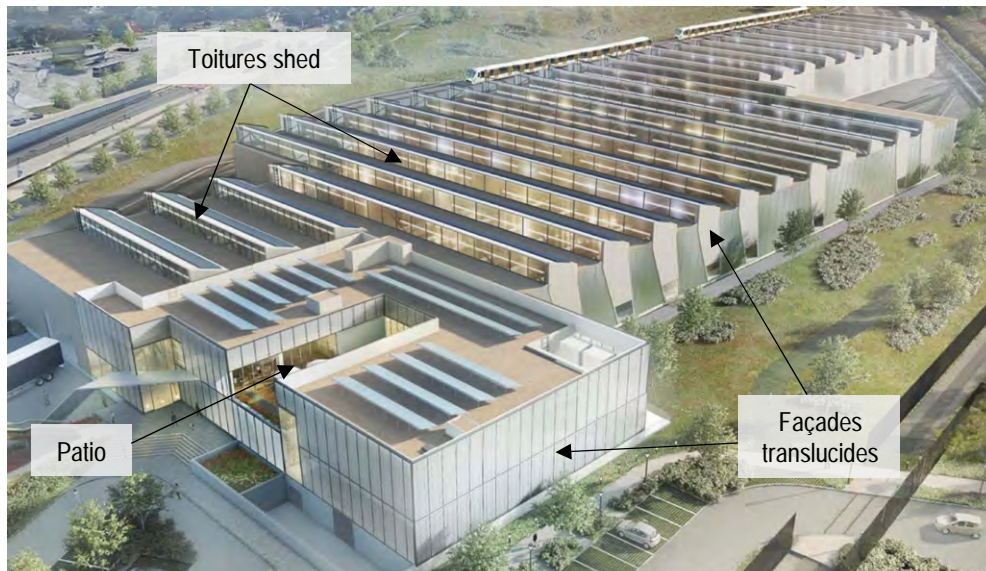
Vue 3D du site du dépôt (ARIES sur fond BMN, 2017)
